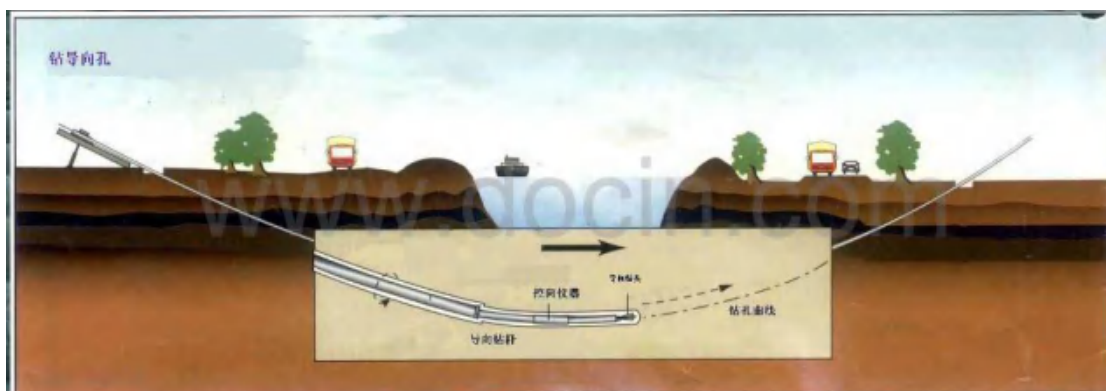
a 定向钻穿越施工导向孔过程断面示意图
